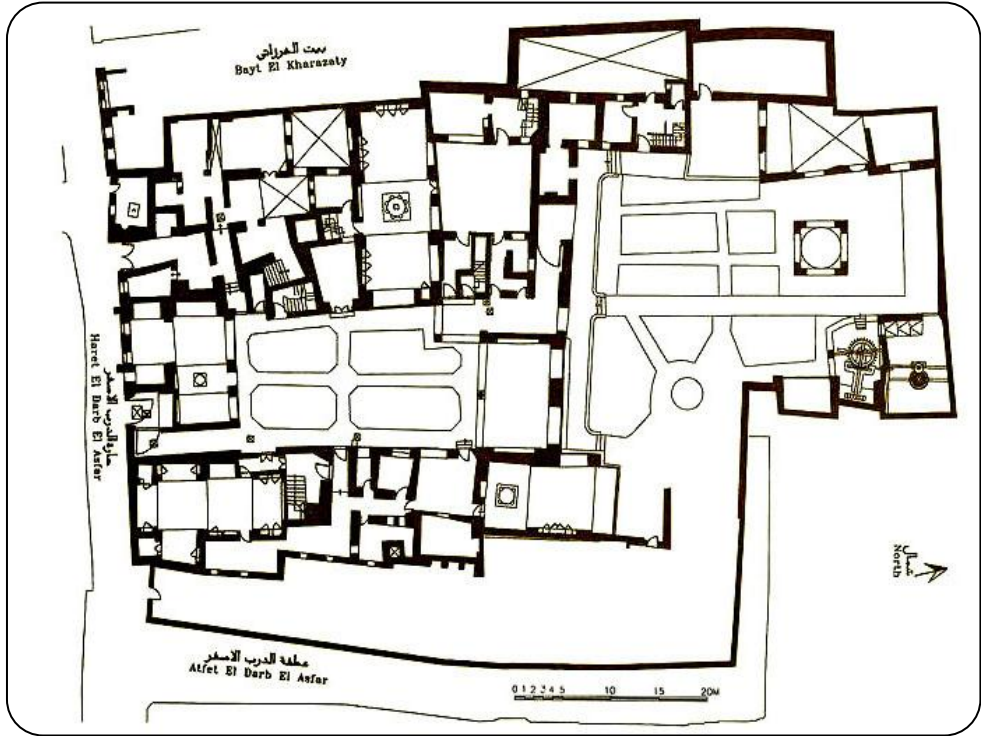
المسقط الأفقي للدور الأرضي لمتزل الست وسيلة
